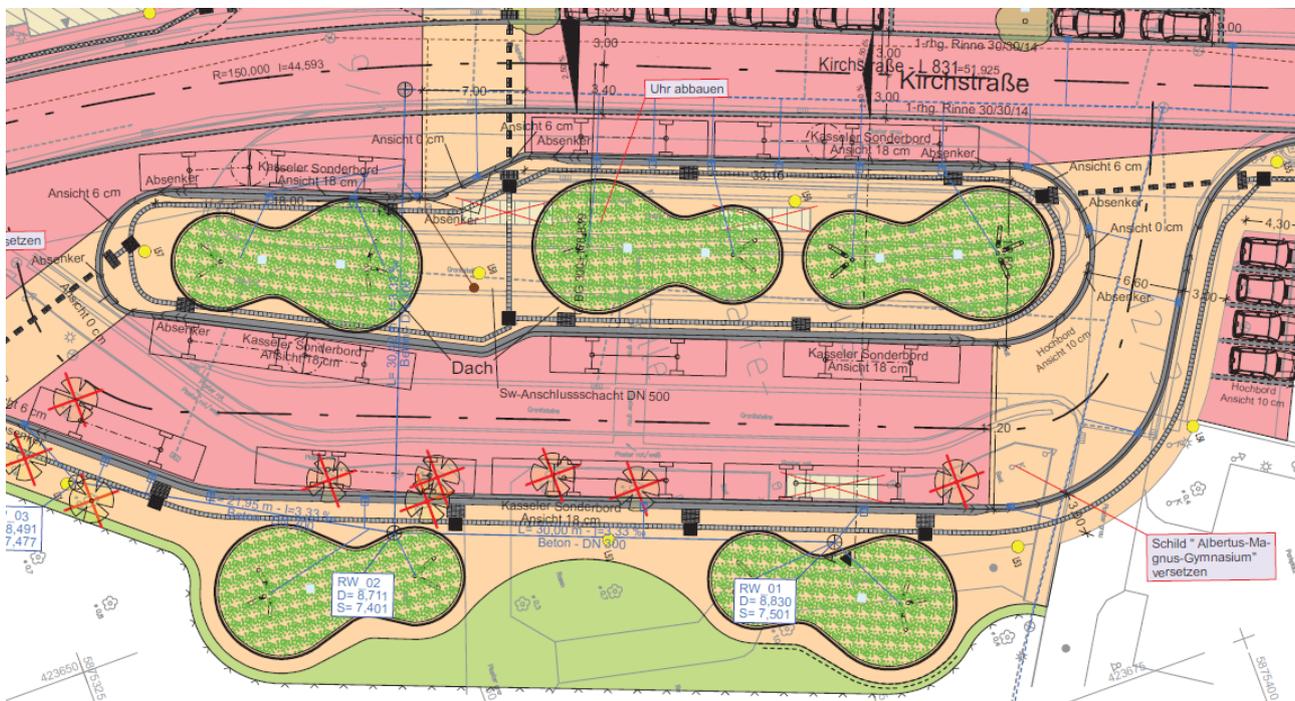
Ausschnitt aus dem Lageplan, Entwurf der SHP Ingenieure, Stand: April 2021
